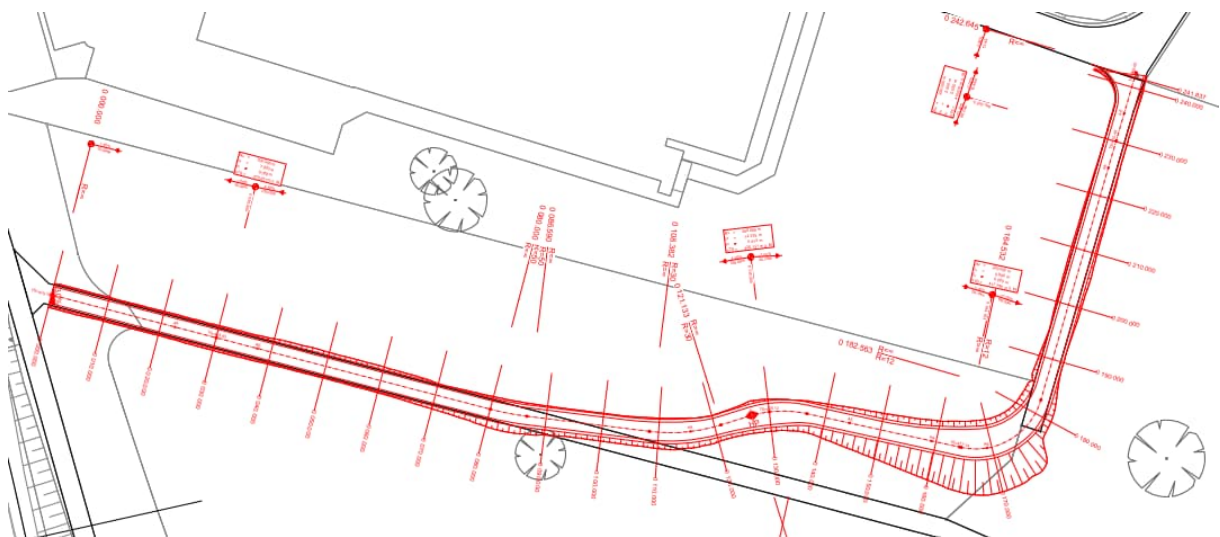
Geplante angepasste Baupiste, genordnete nicht massstäbliche Darstellung
